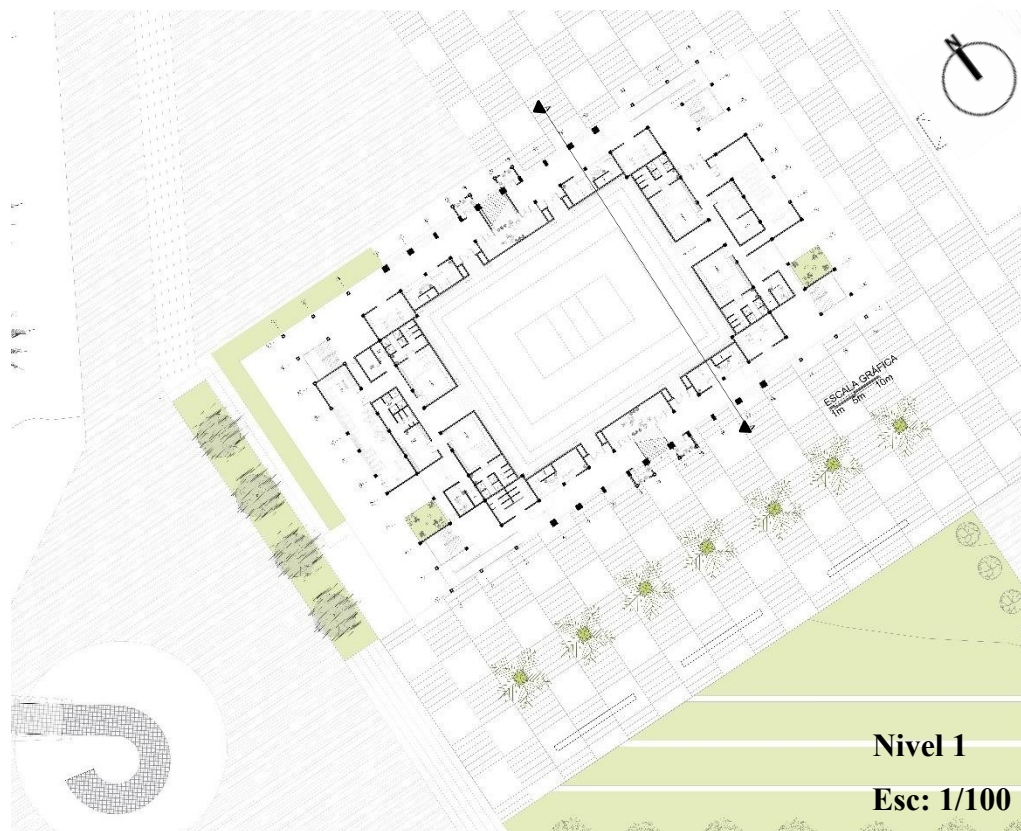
Planta 1 Escenario Múltiple Voley-Basquet
